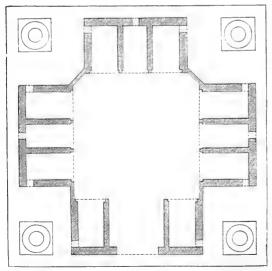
Grundriß zu einem 22fächerigen Pavillon.
